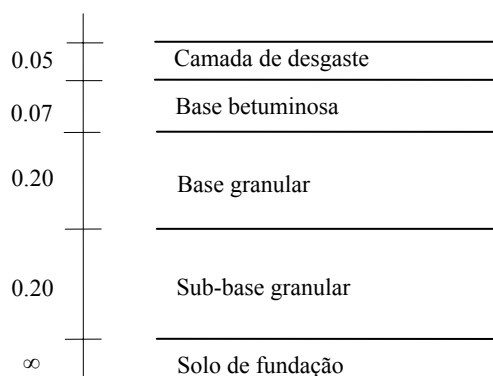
Estrutura do pavimento do segundo caso de estudo
